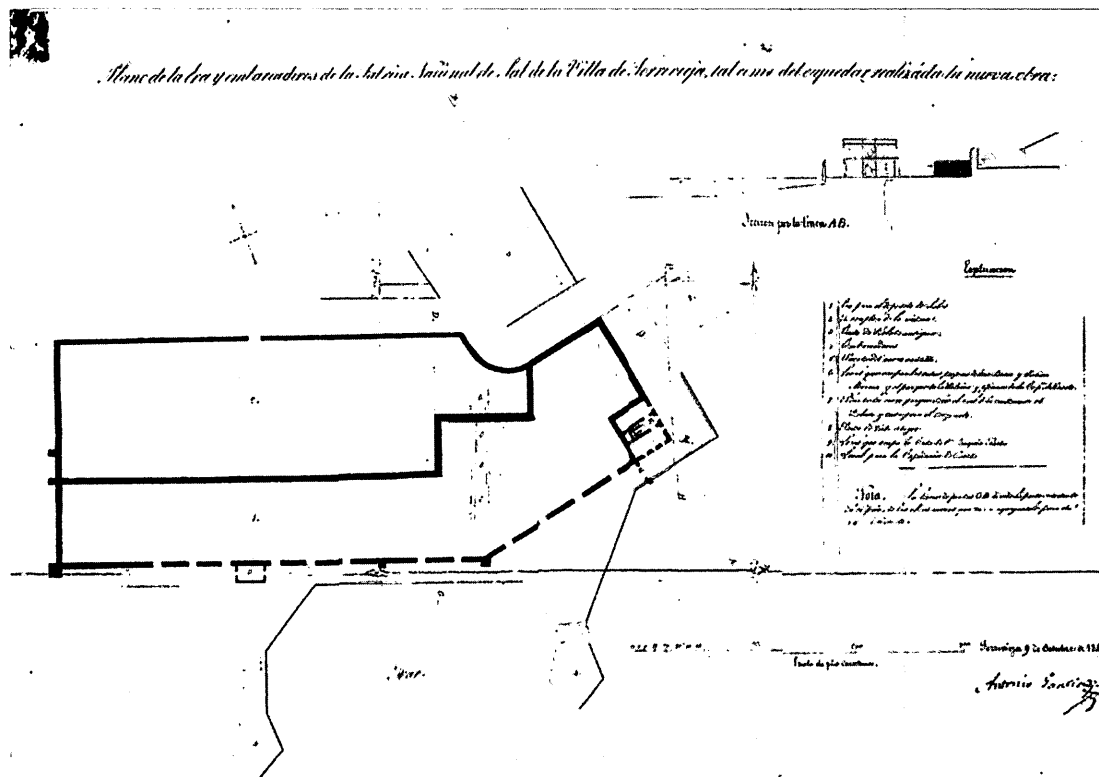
Plano de proyecto de construcción de la nueva Era y muelle de levante (1835).
